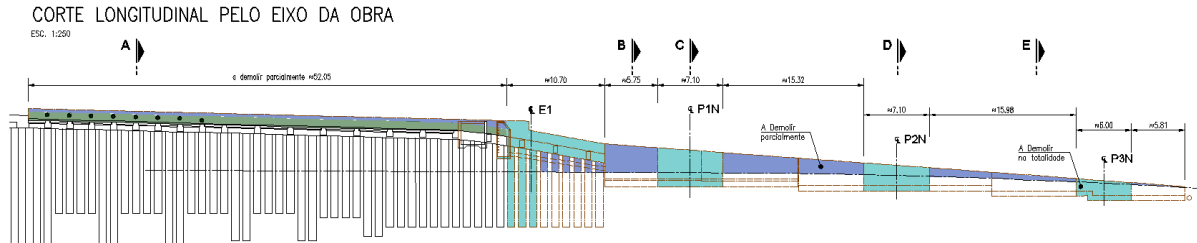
Corte longitudinal na VRT com demolições a realizar na estrutura existente
